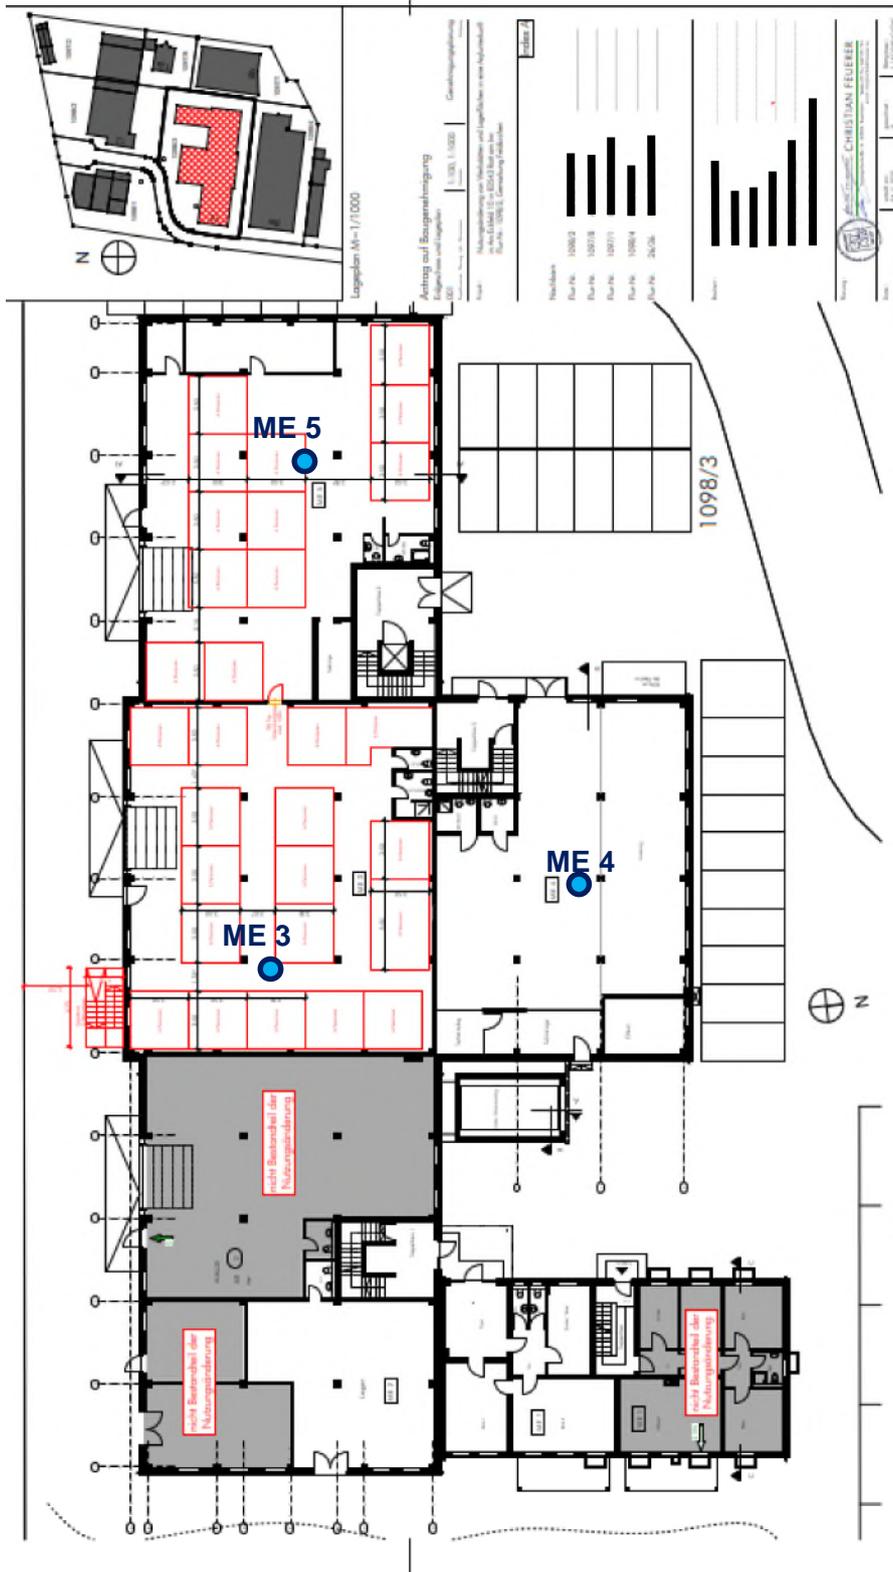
Lageplan Erdgeschoss mit Probenahmestellen.
